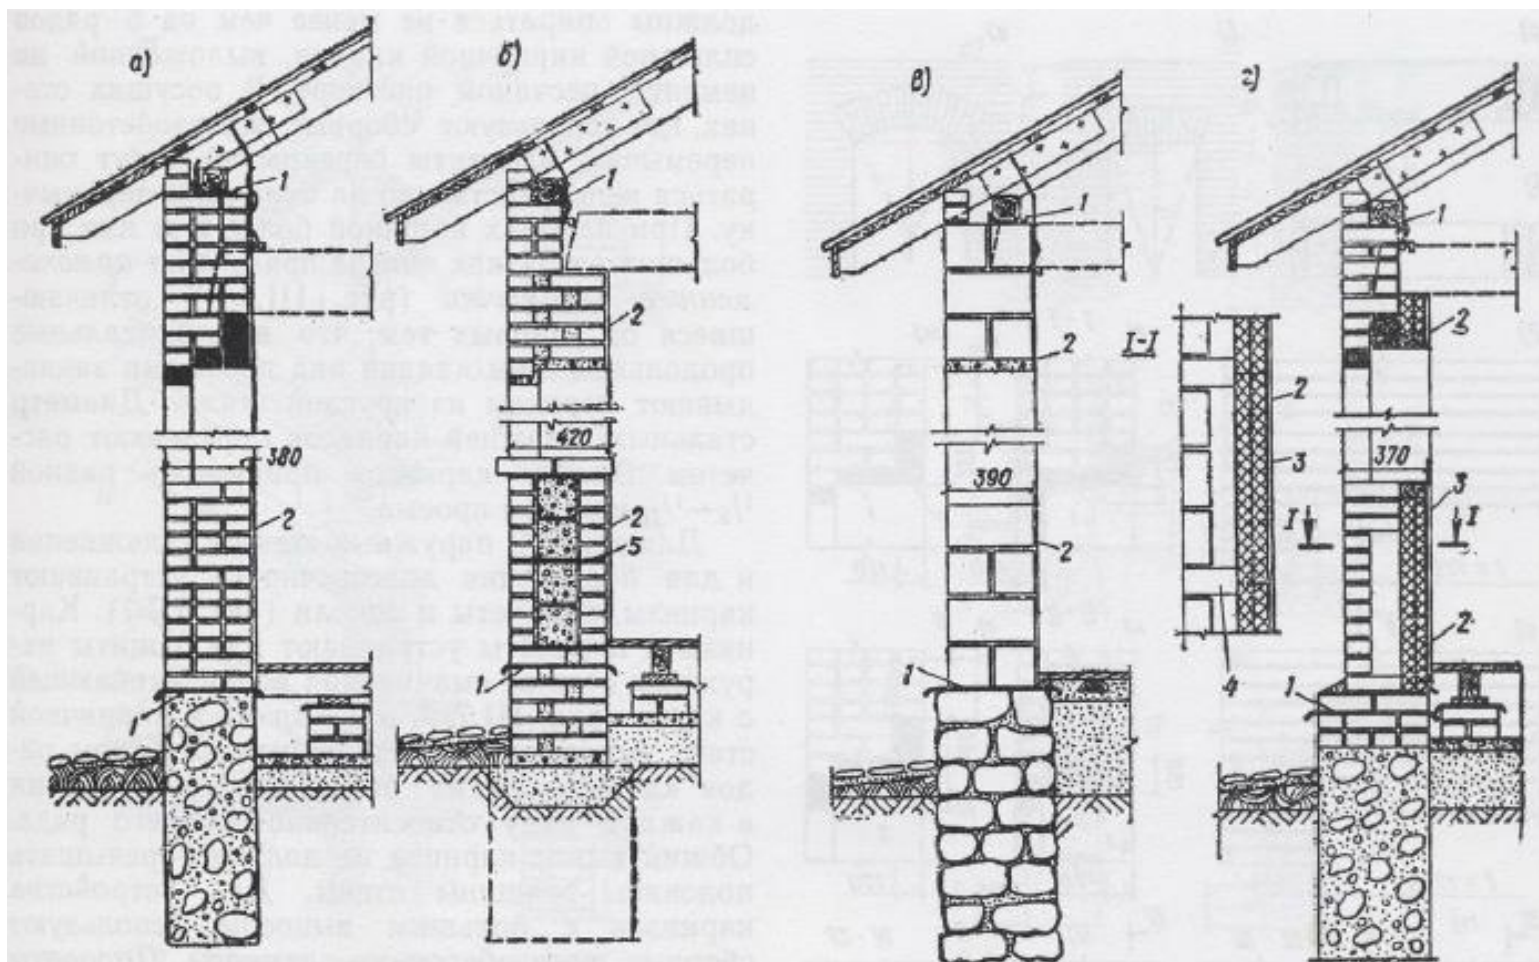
Разрезы наружных несущих стен малоэтажных каменных зданий
